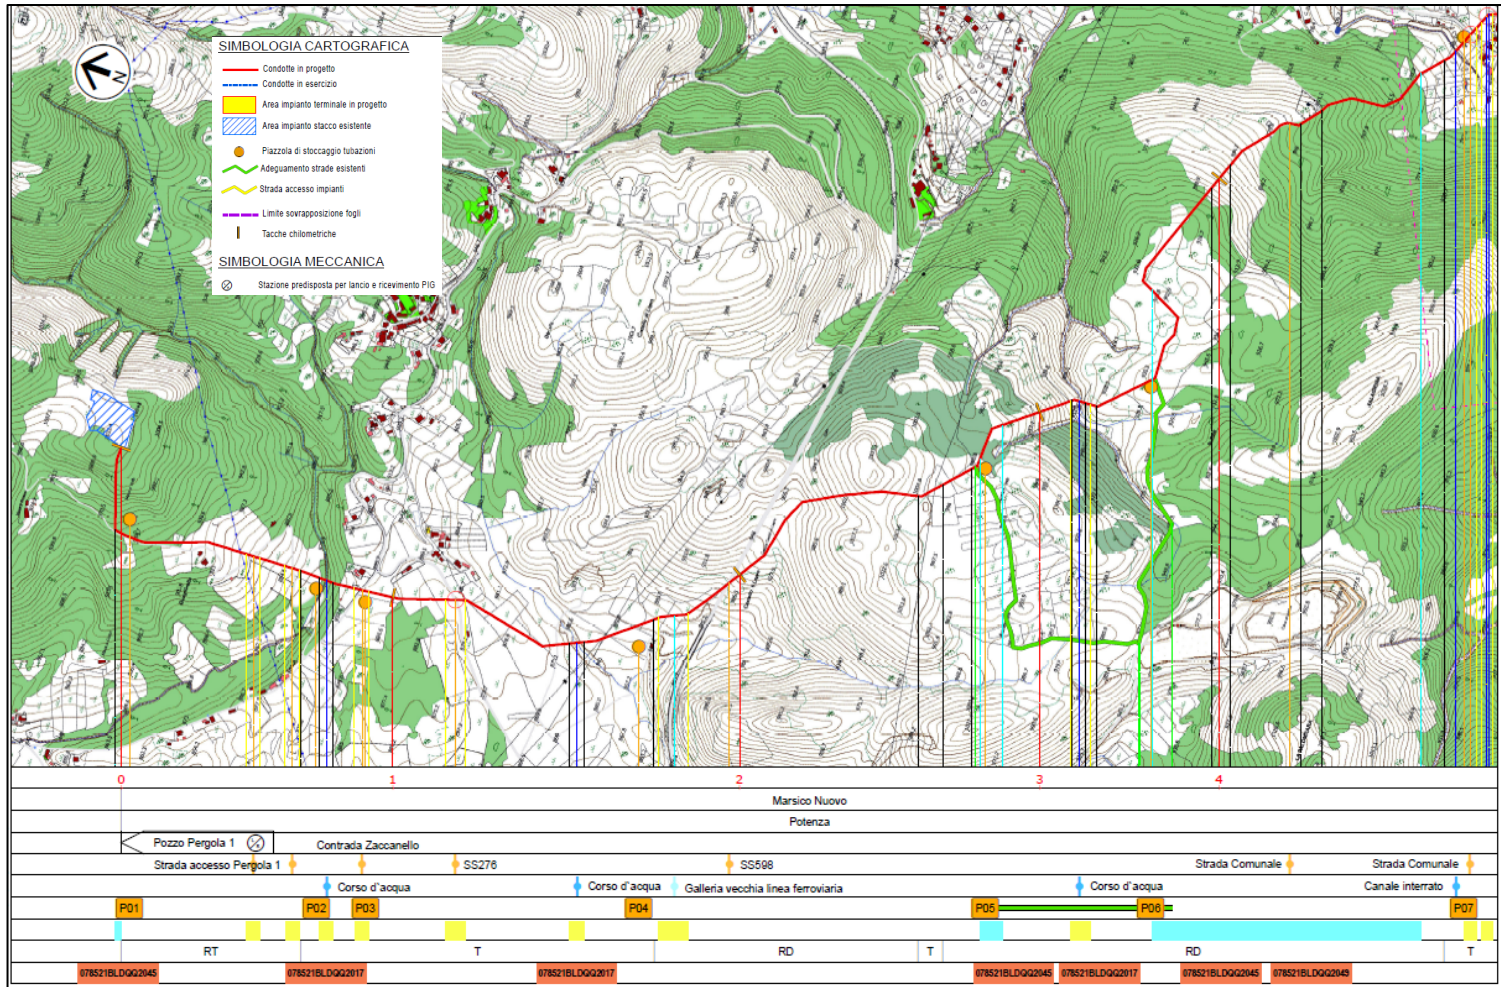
Layout cantiere ed ubicazione infrastrutture provvisorie (1 di 2)
